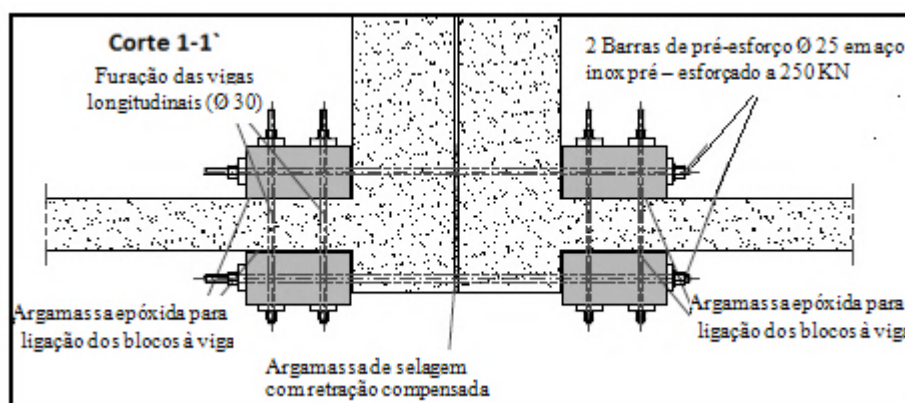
Pormenor da ligação das vigas e carlingas em corte 1-1' (Brisa, 2002b).
